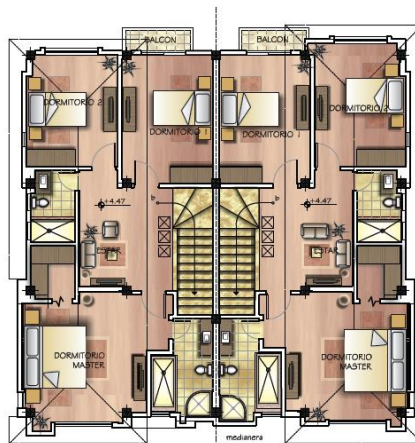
Planos Arquitectónicos Fuente: Arquitectos & Consultores
